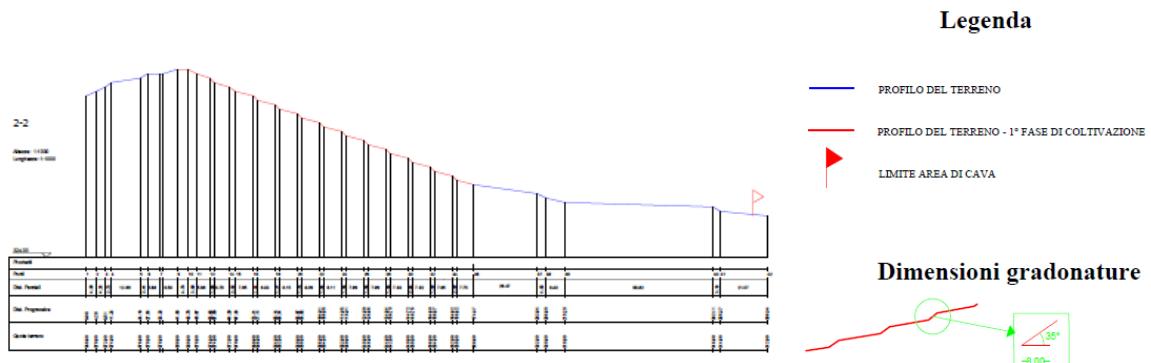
SEZIONE TIPO_1° STADIO DI COLTIVAZIONE
